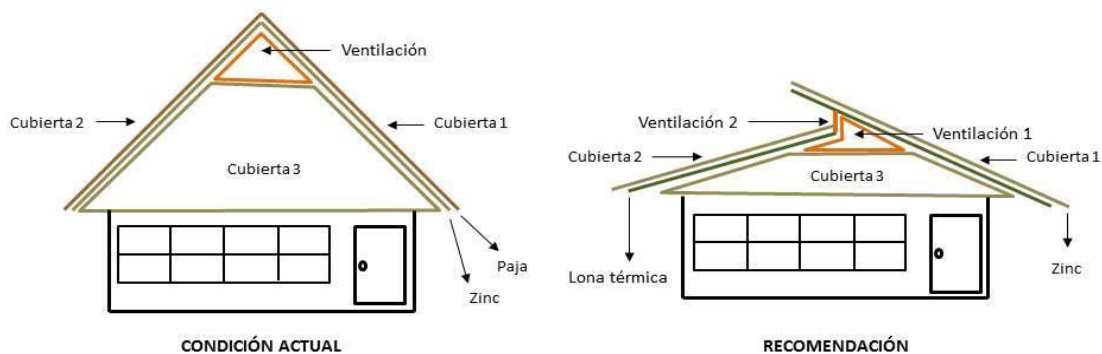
Estructura Cubiertas Cabañas Yewae, Fuente: Elaboración Propia
